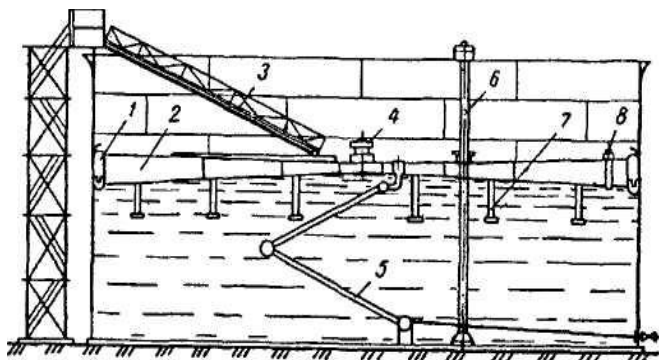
Конструкція резервуару із плавальним дахом:
